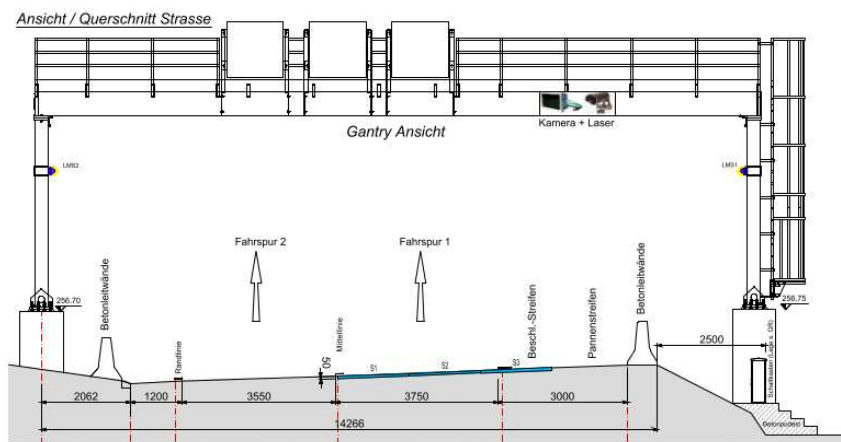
Einbauplan Ansicht Schilderbrücke
